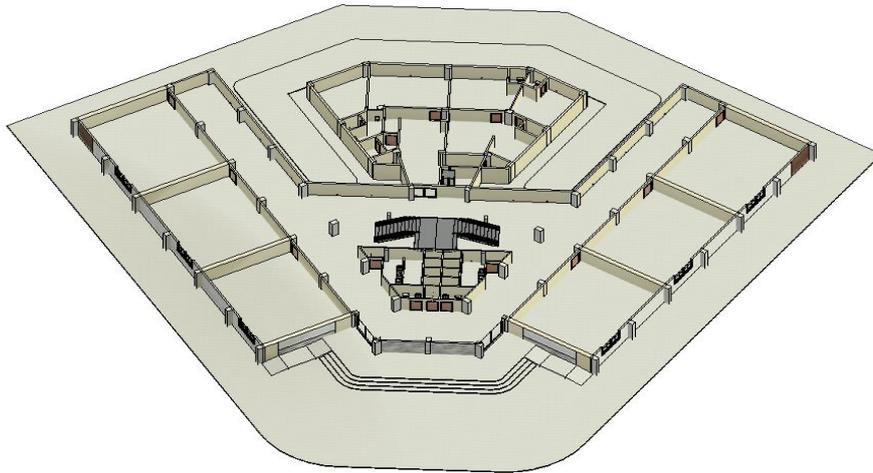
ARQUITECTÓNICO 3D.
